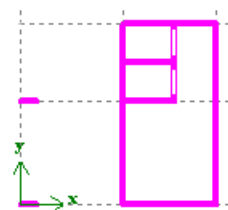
Отверстия в стене (фрагмент плана)
